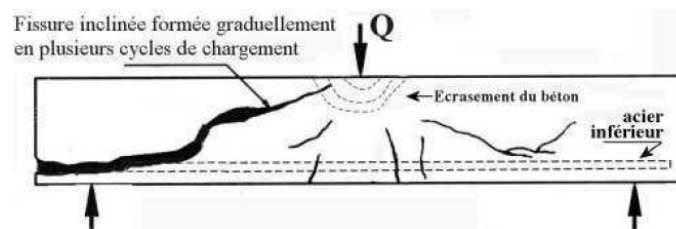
Schéma d'une poutre béton armé endommagée par rupture d'adhérence par cisaillement [CROSTON\_06]
